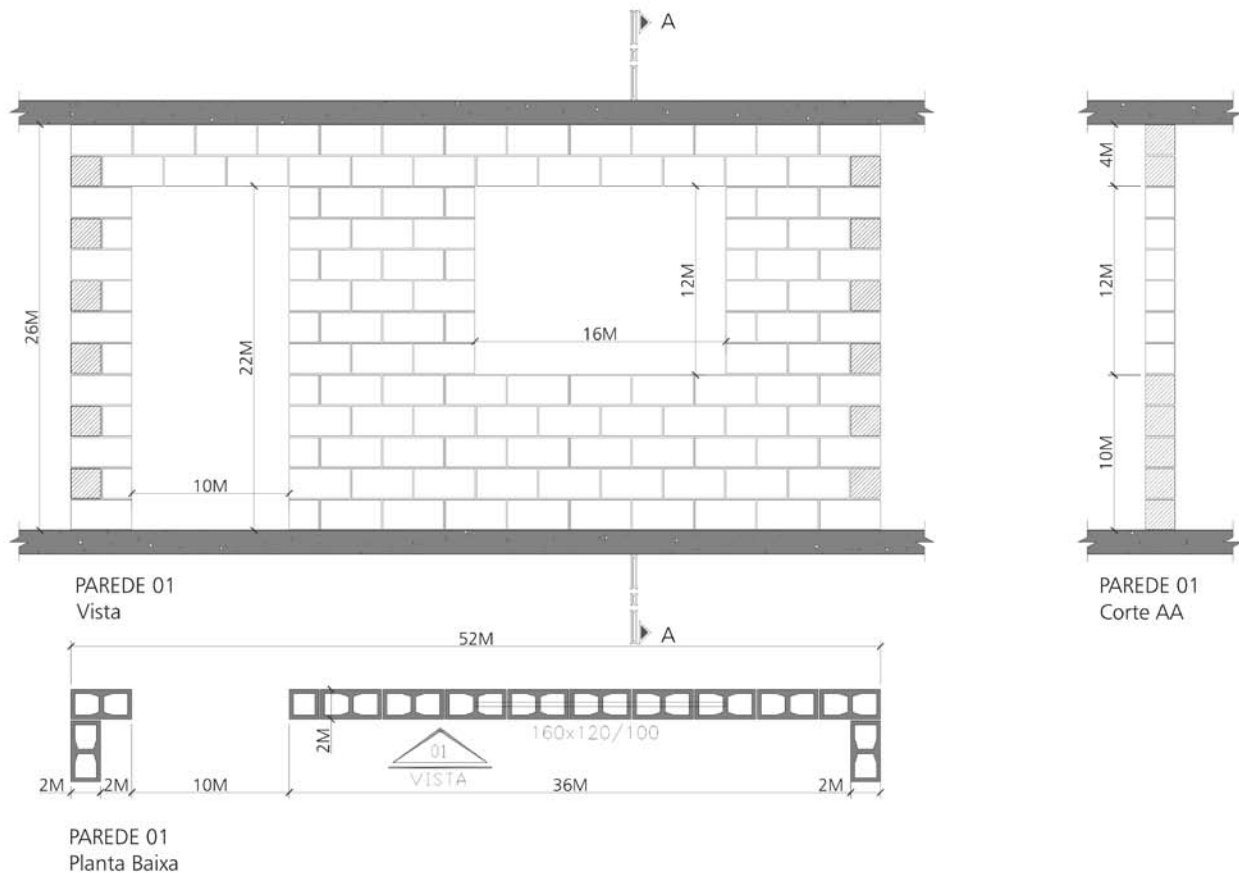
Elevação de parede executada em alvenaria modular de blocos
